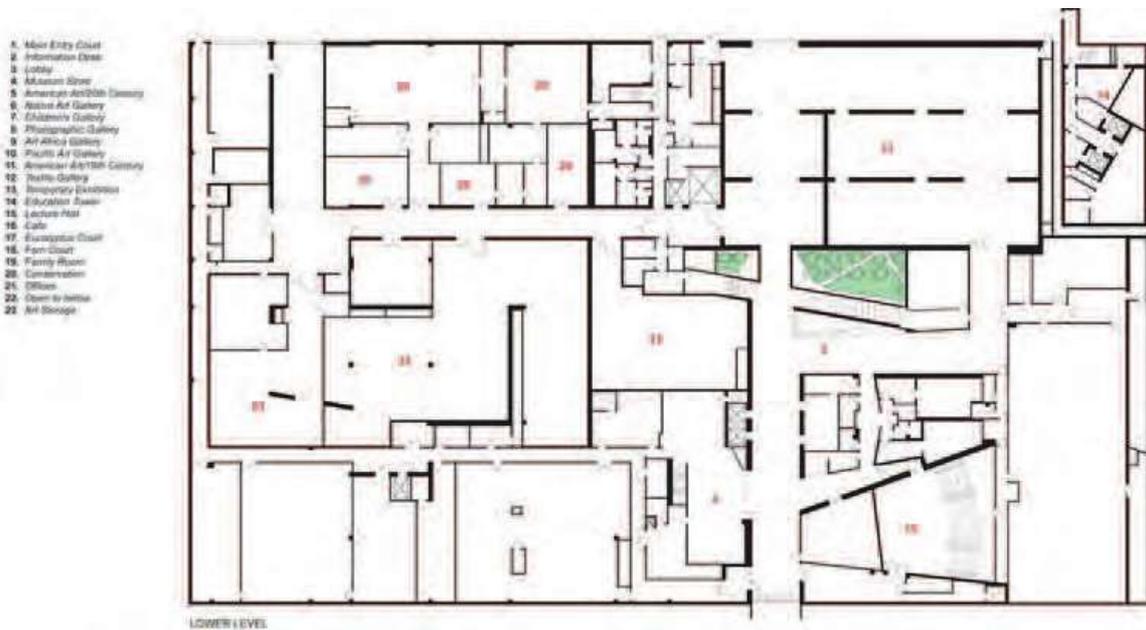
Museo de Young, San Francisco, Planta arquitectónica
